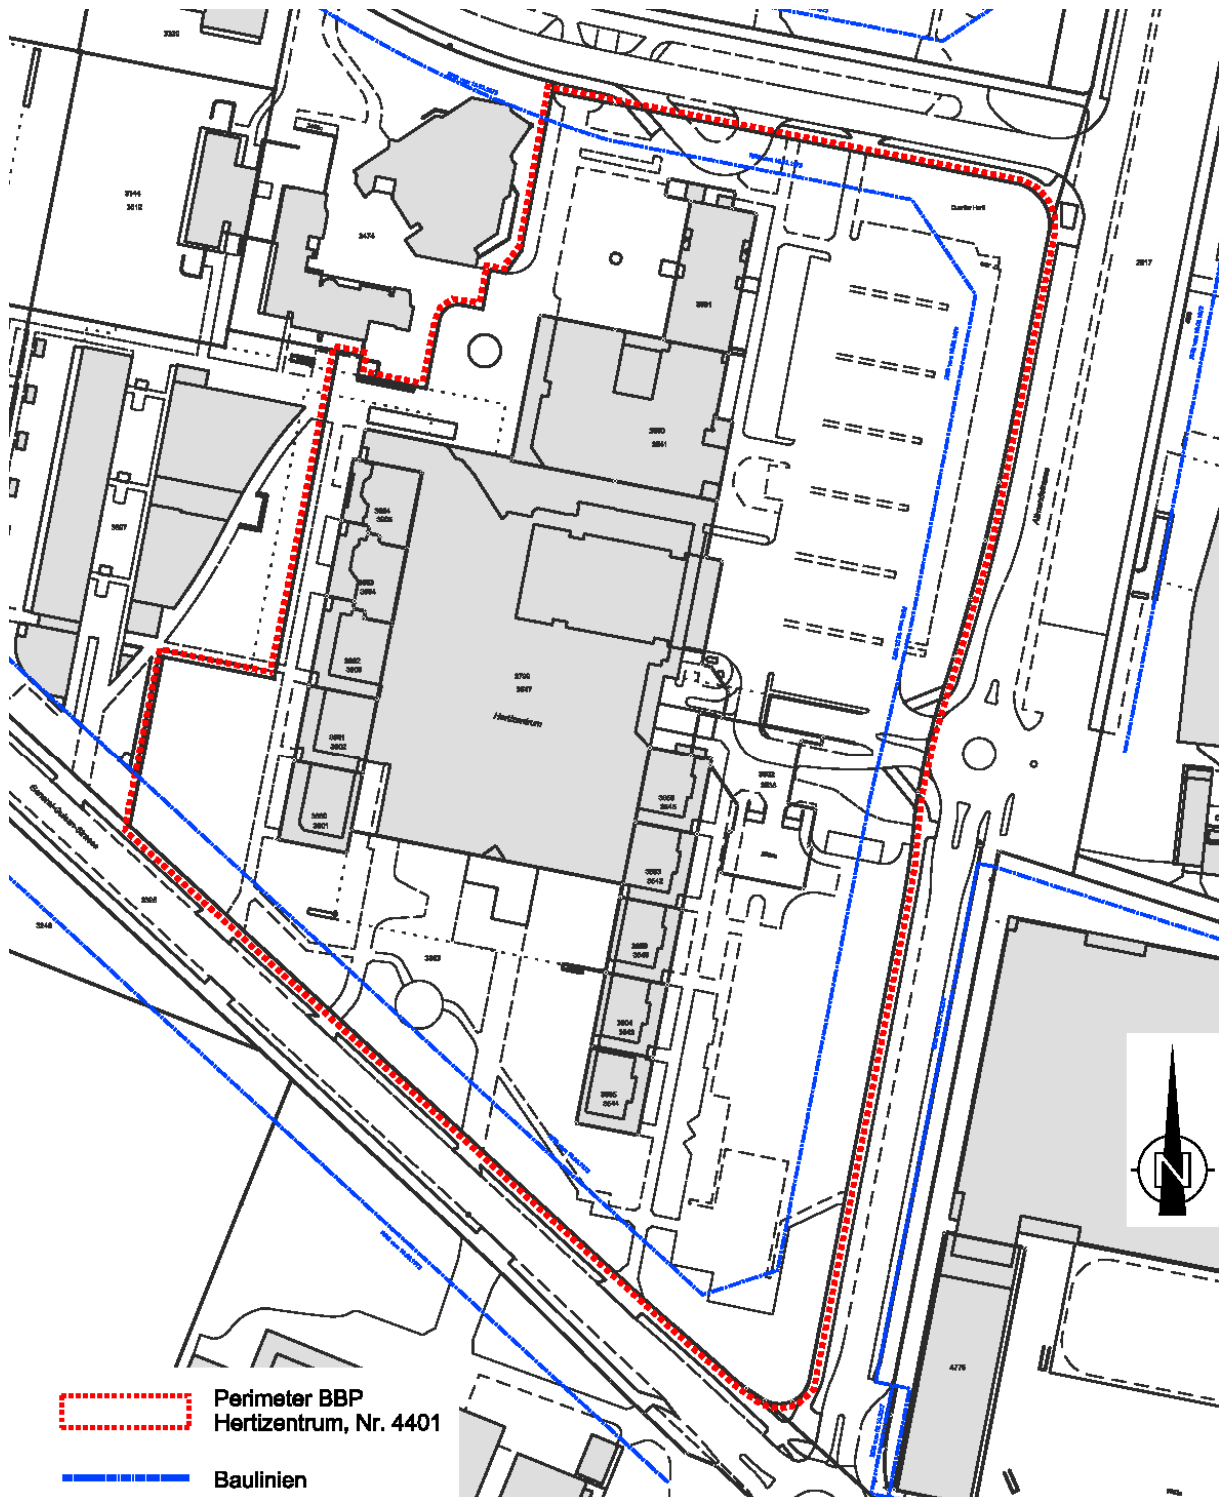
Übersichtsplan mit Bebauungsplanperimeter gemäss Verfahrenseinleitung, Quelle: Bau-departement
